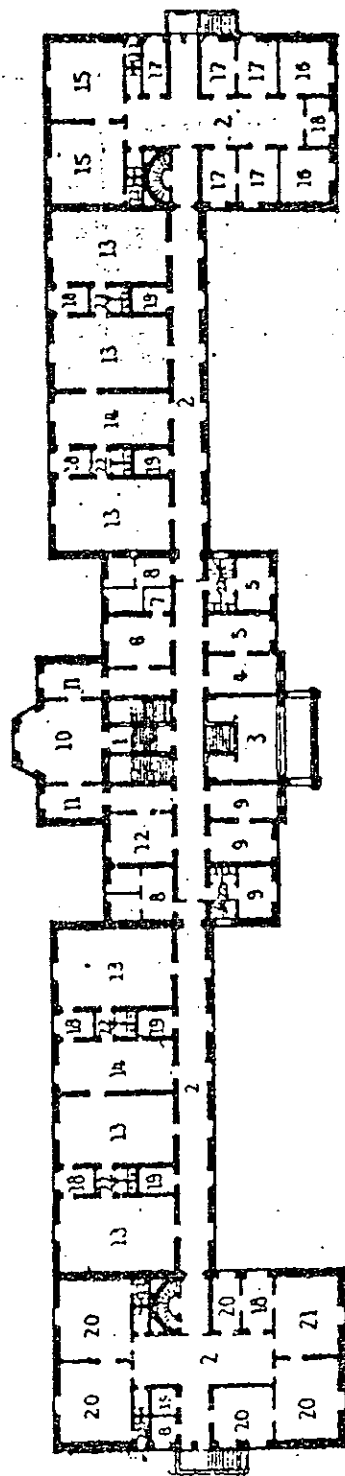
Bâtiment principal. Plan du rez-de-chaussée. — Échelle de 0,0001 p. 1 mètre.
